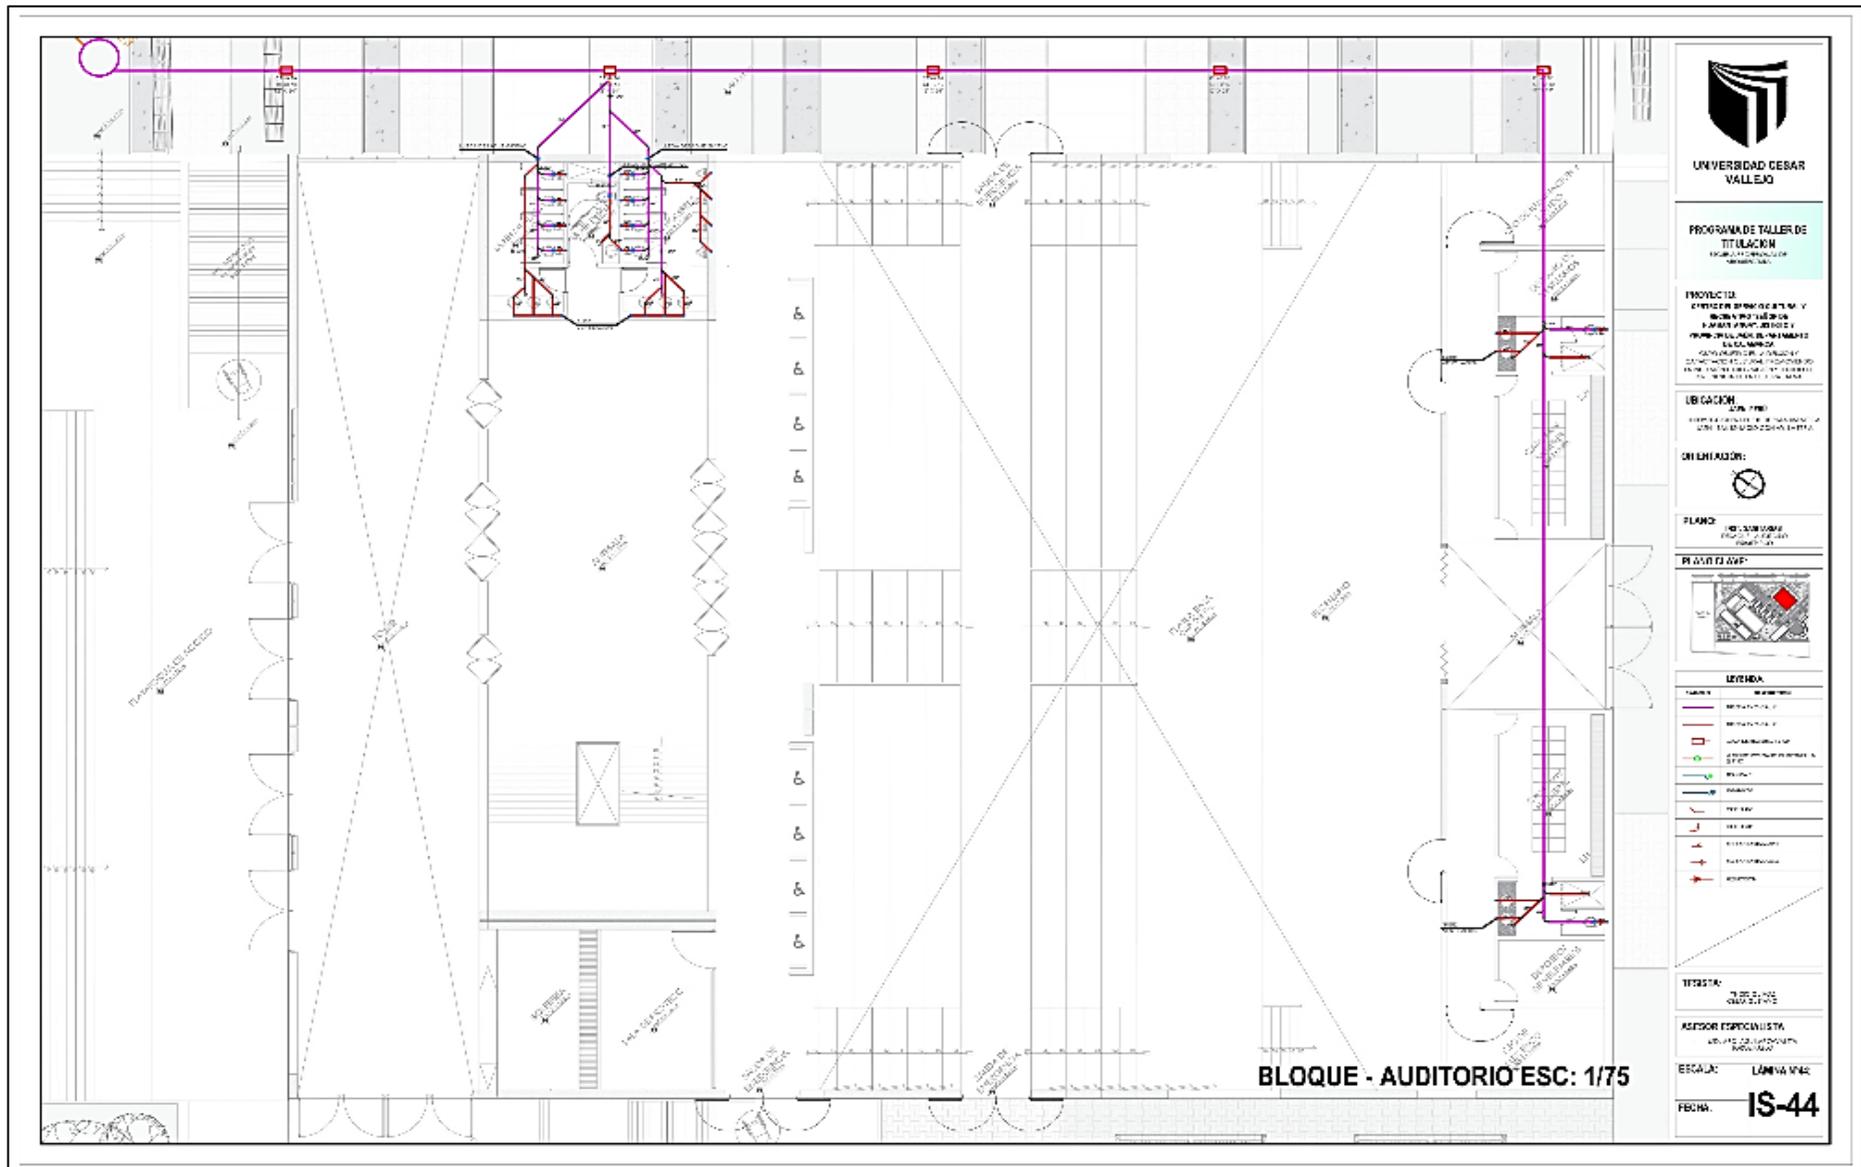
Planta de distribución de desagüe 1er nivel – auditorio
